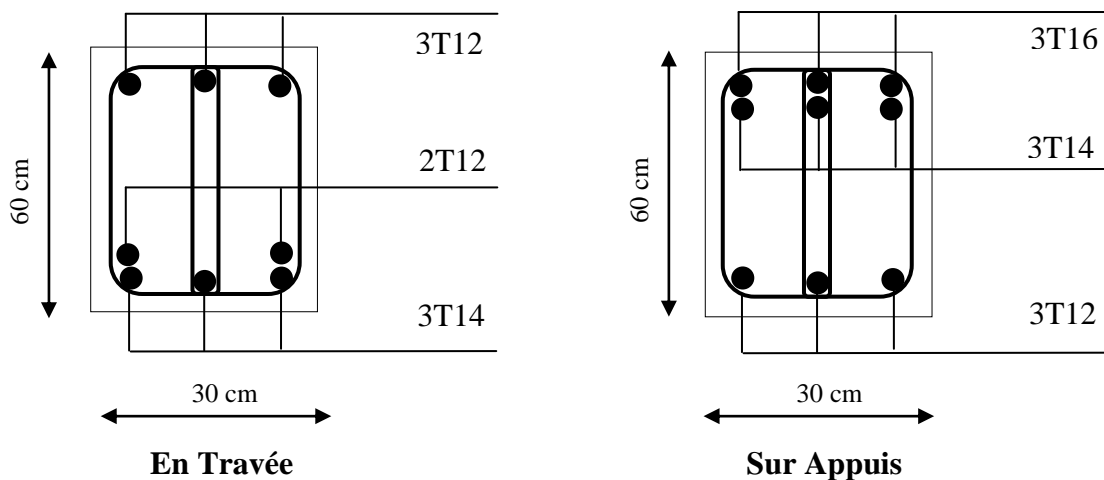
Schéma de ferrailage d'une poutre principale (Terrasse)
